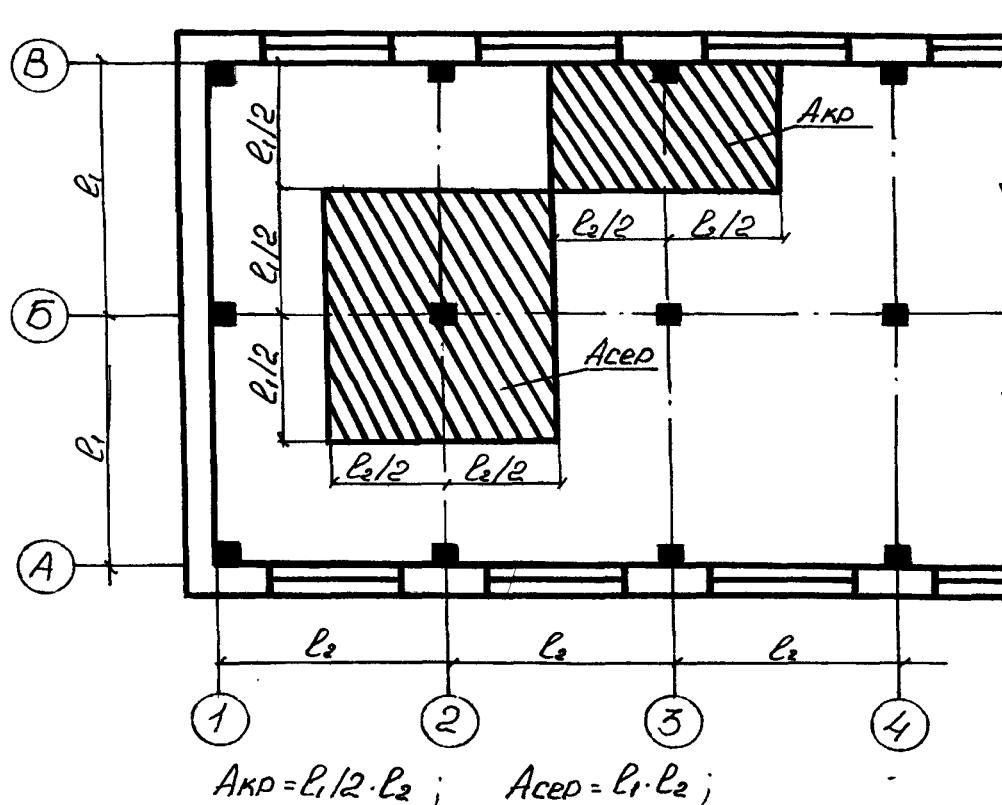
Схематичний план будівлі та вантажні площі для розрахункових фундаментів
